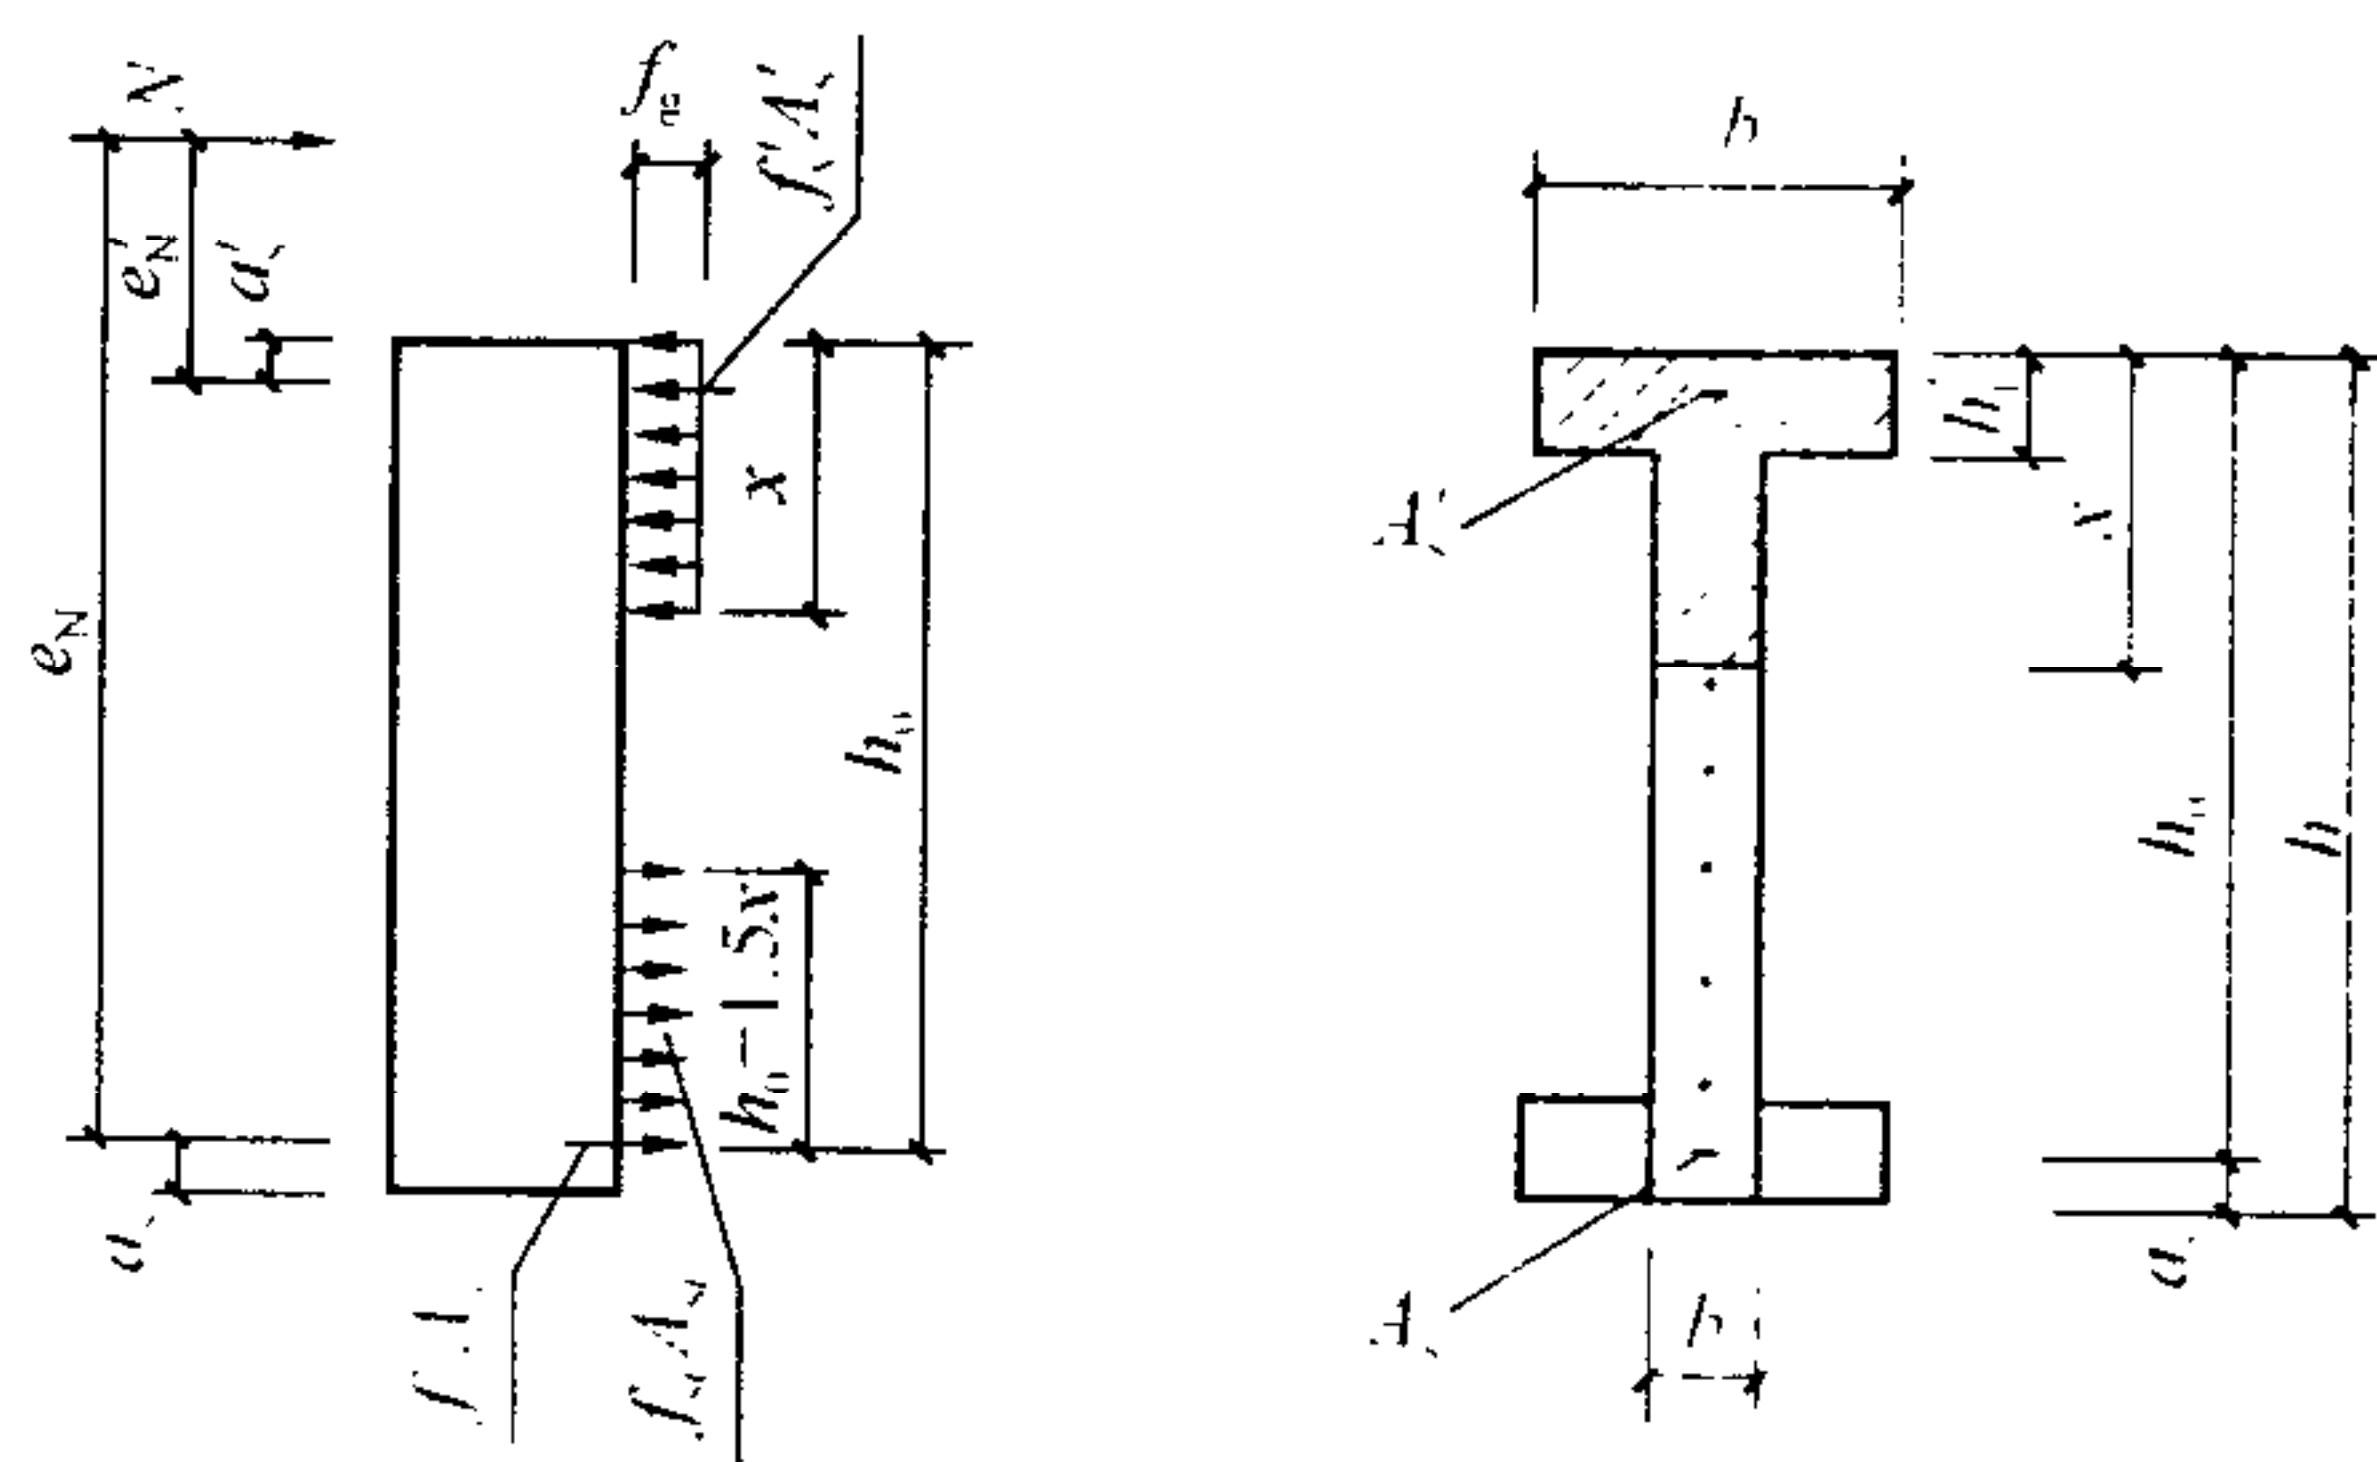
T 形截面偏心受压构件正截面承载力计算简图
